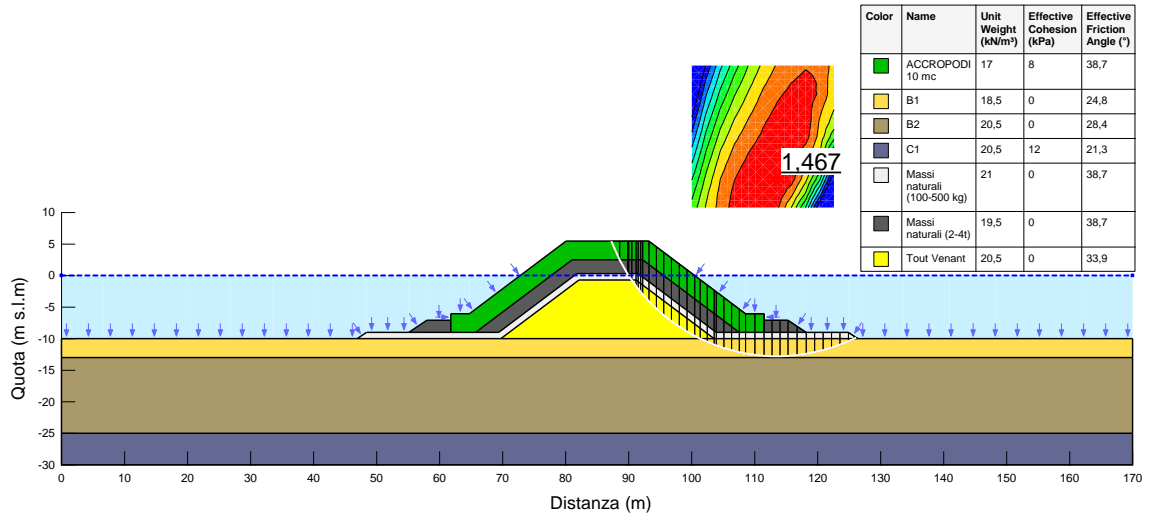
Sezione C – SLU-GEO 2– Superficie critica destra
